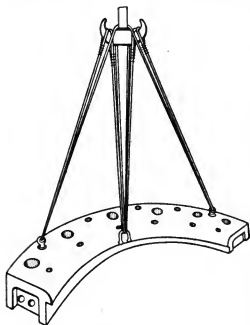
Схема строповки несимметричной сегментной детали.
